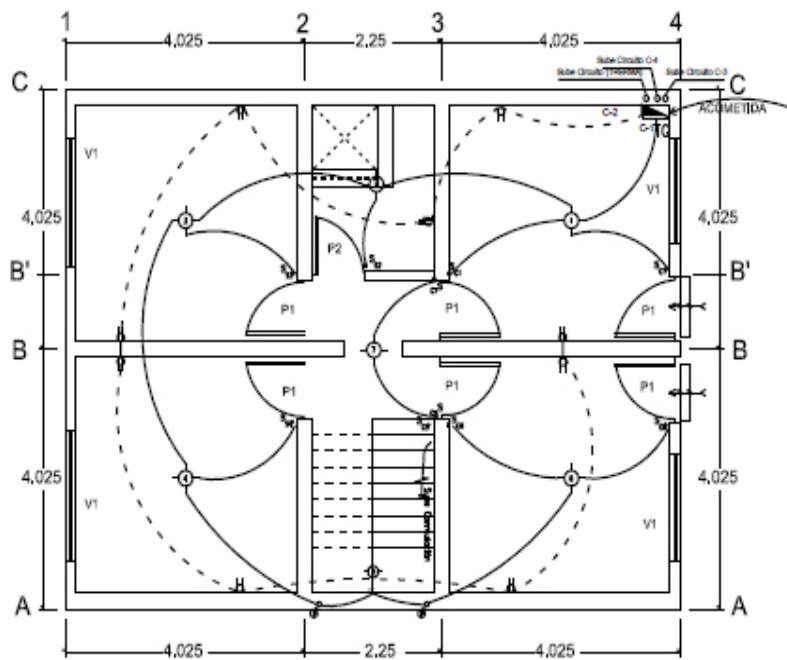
Ejemplo Plano Instalaciones Eléctricas
